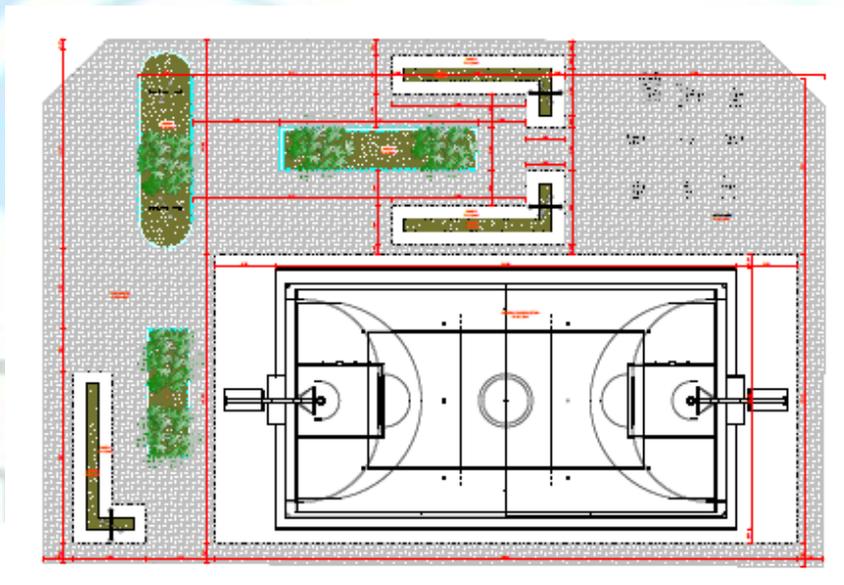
Planta baixa da área de Lazer/Quadra/Praça
